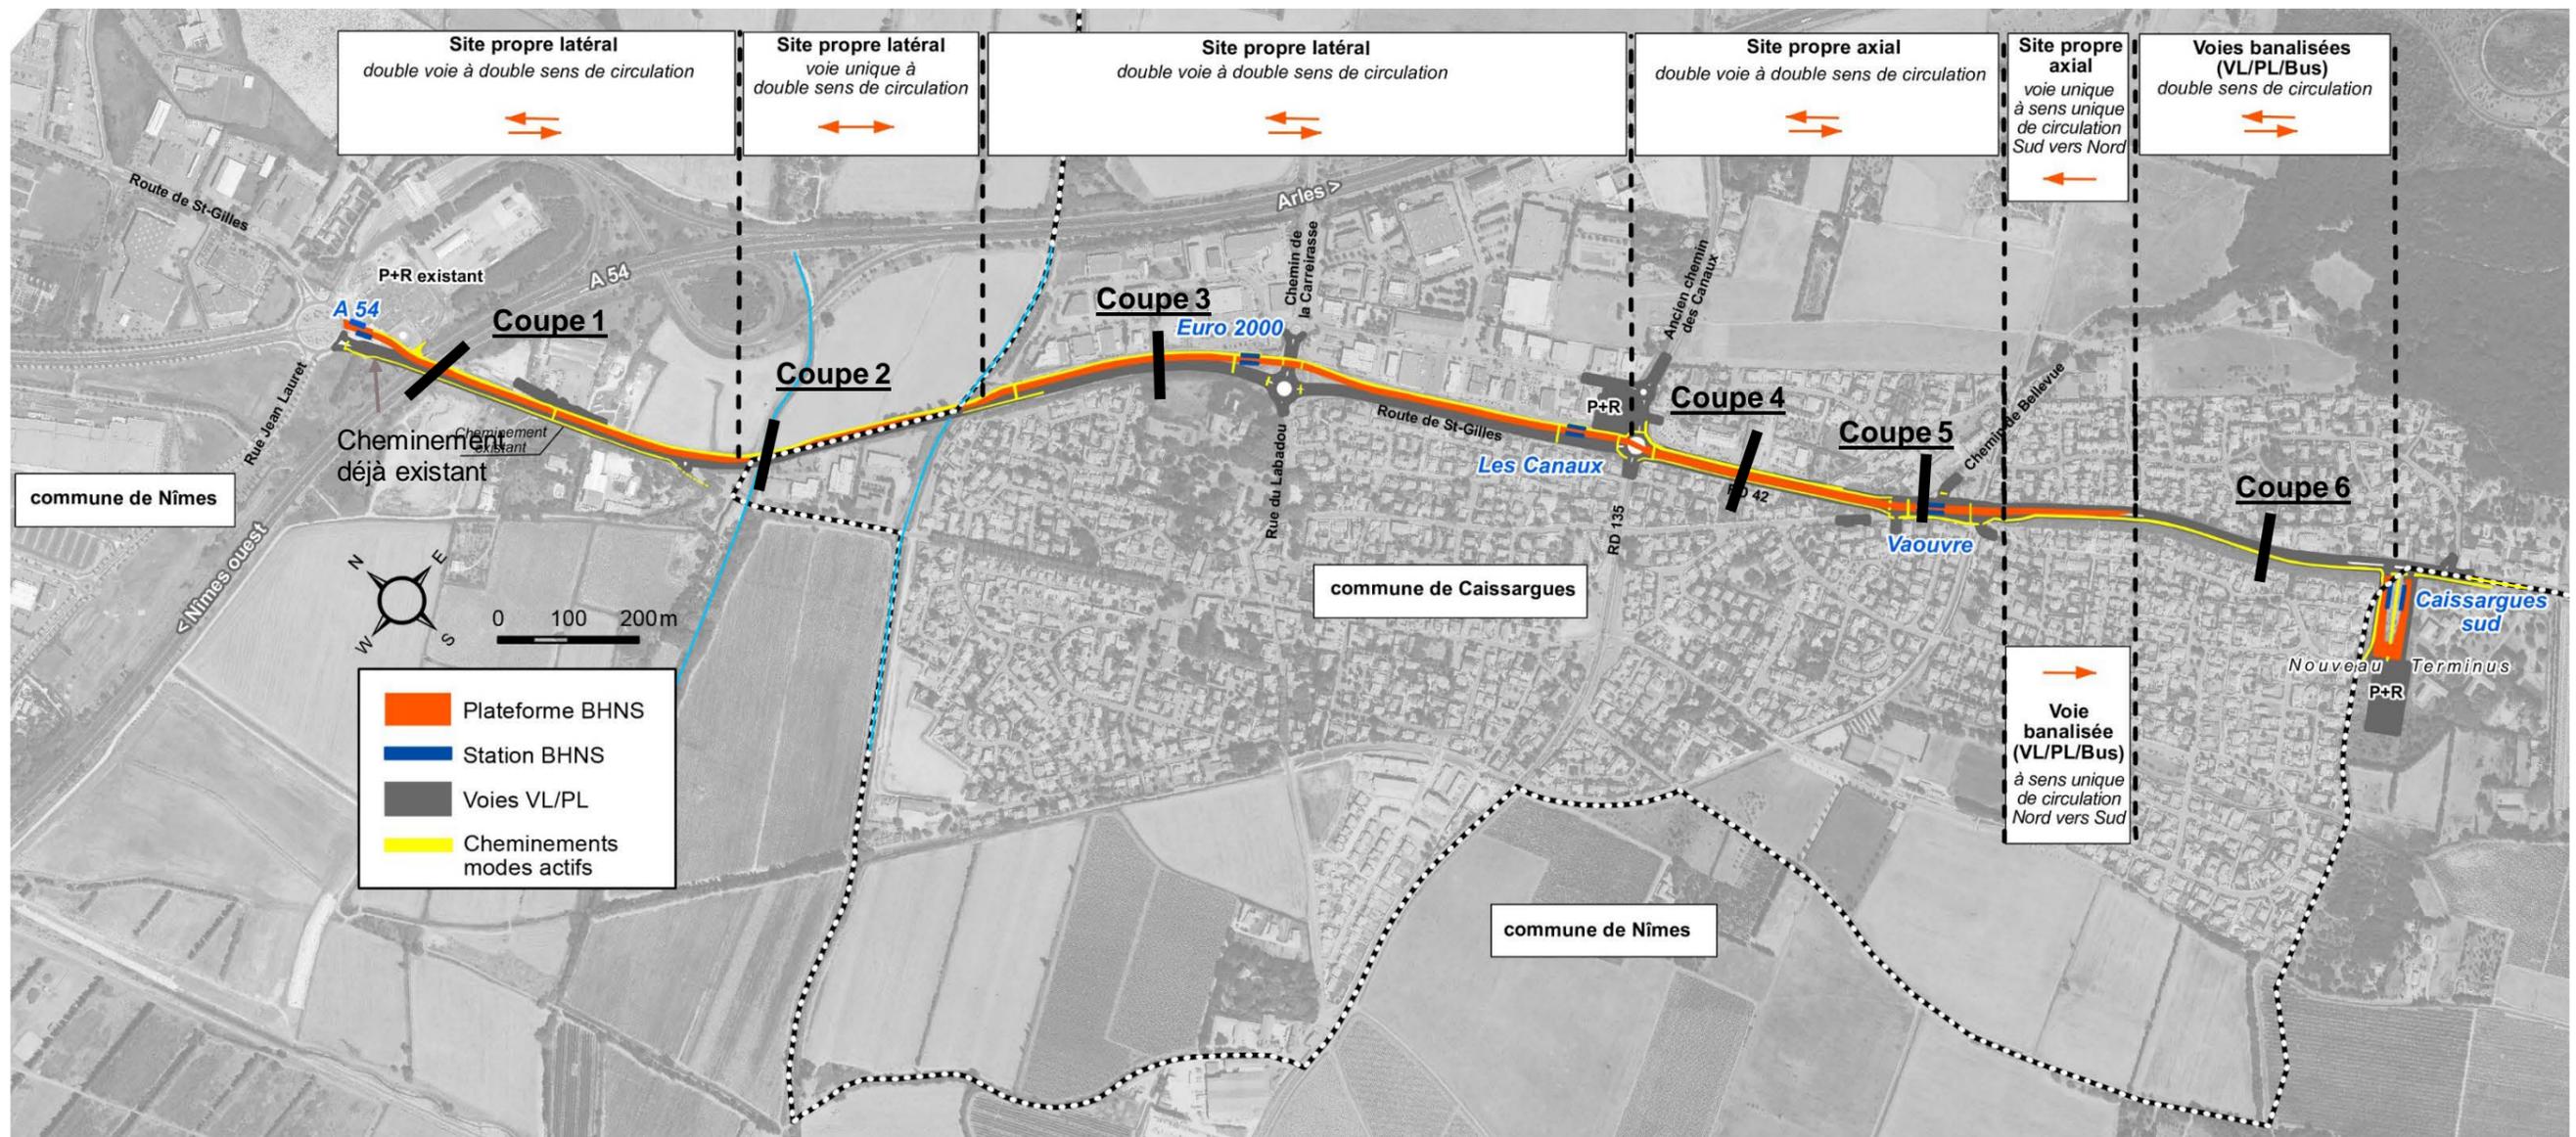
Localisation des coupes sur le plan synoptique du tracé de l'extension Sud de la ligne T1
